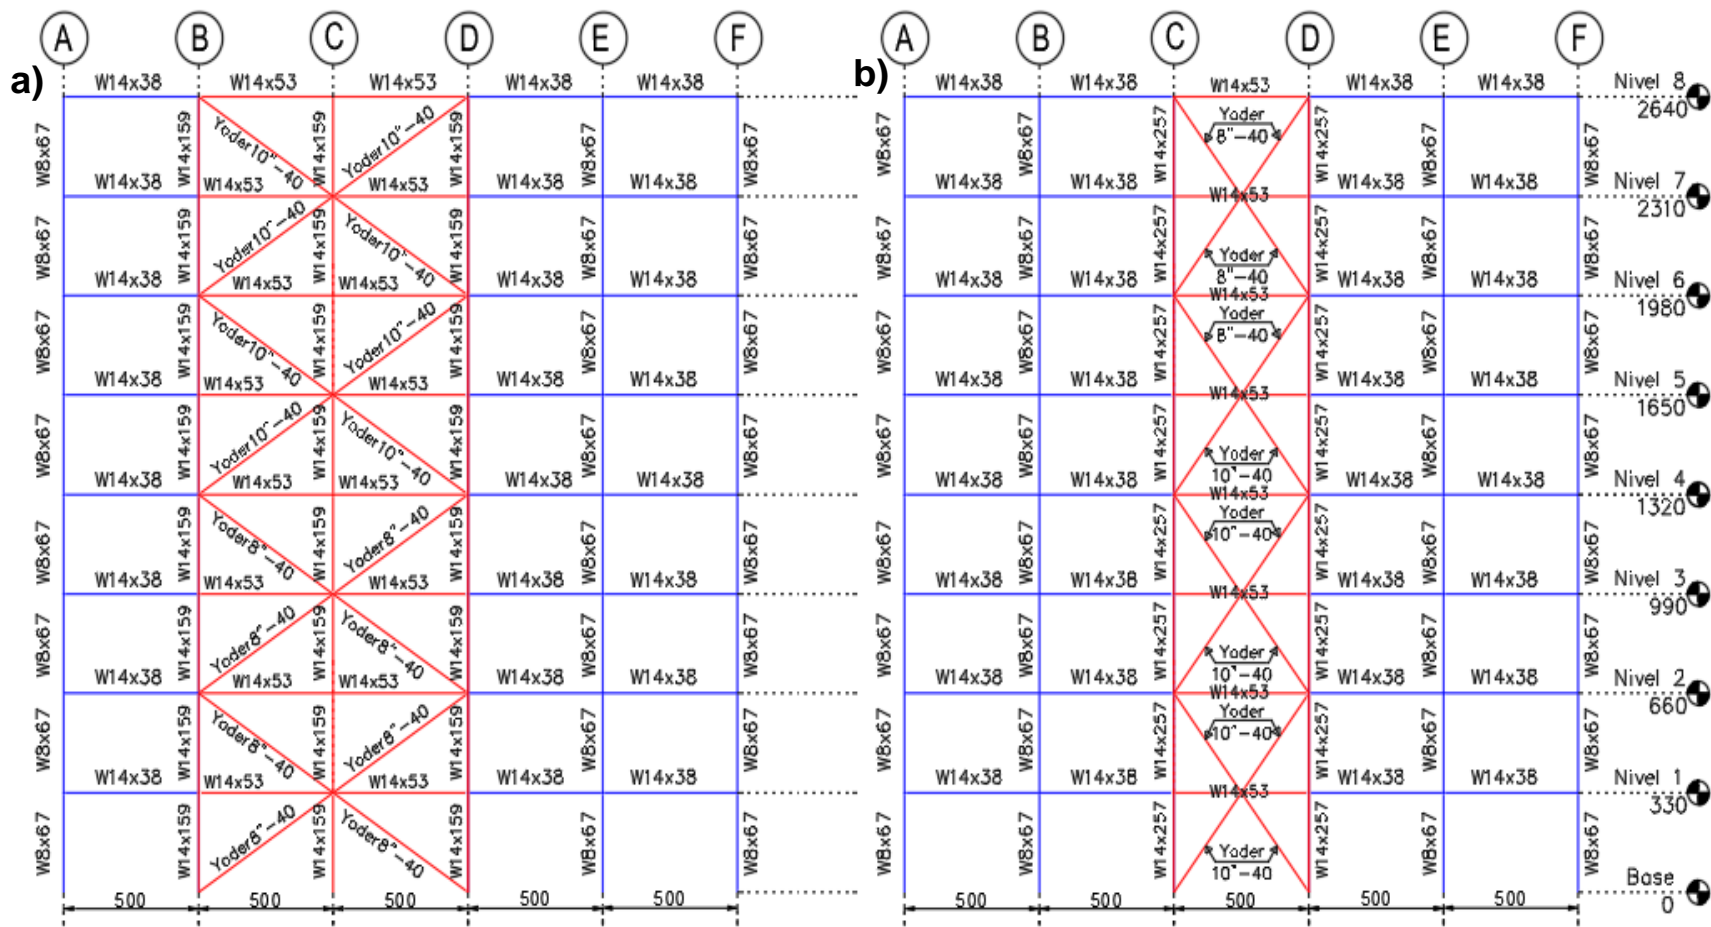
a) Vista en elevación del eje 6 y b) Vista en elevación del eje 5 - edificio de 8 pisos.
